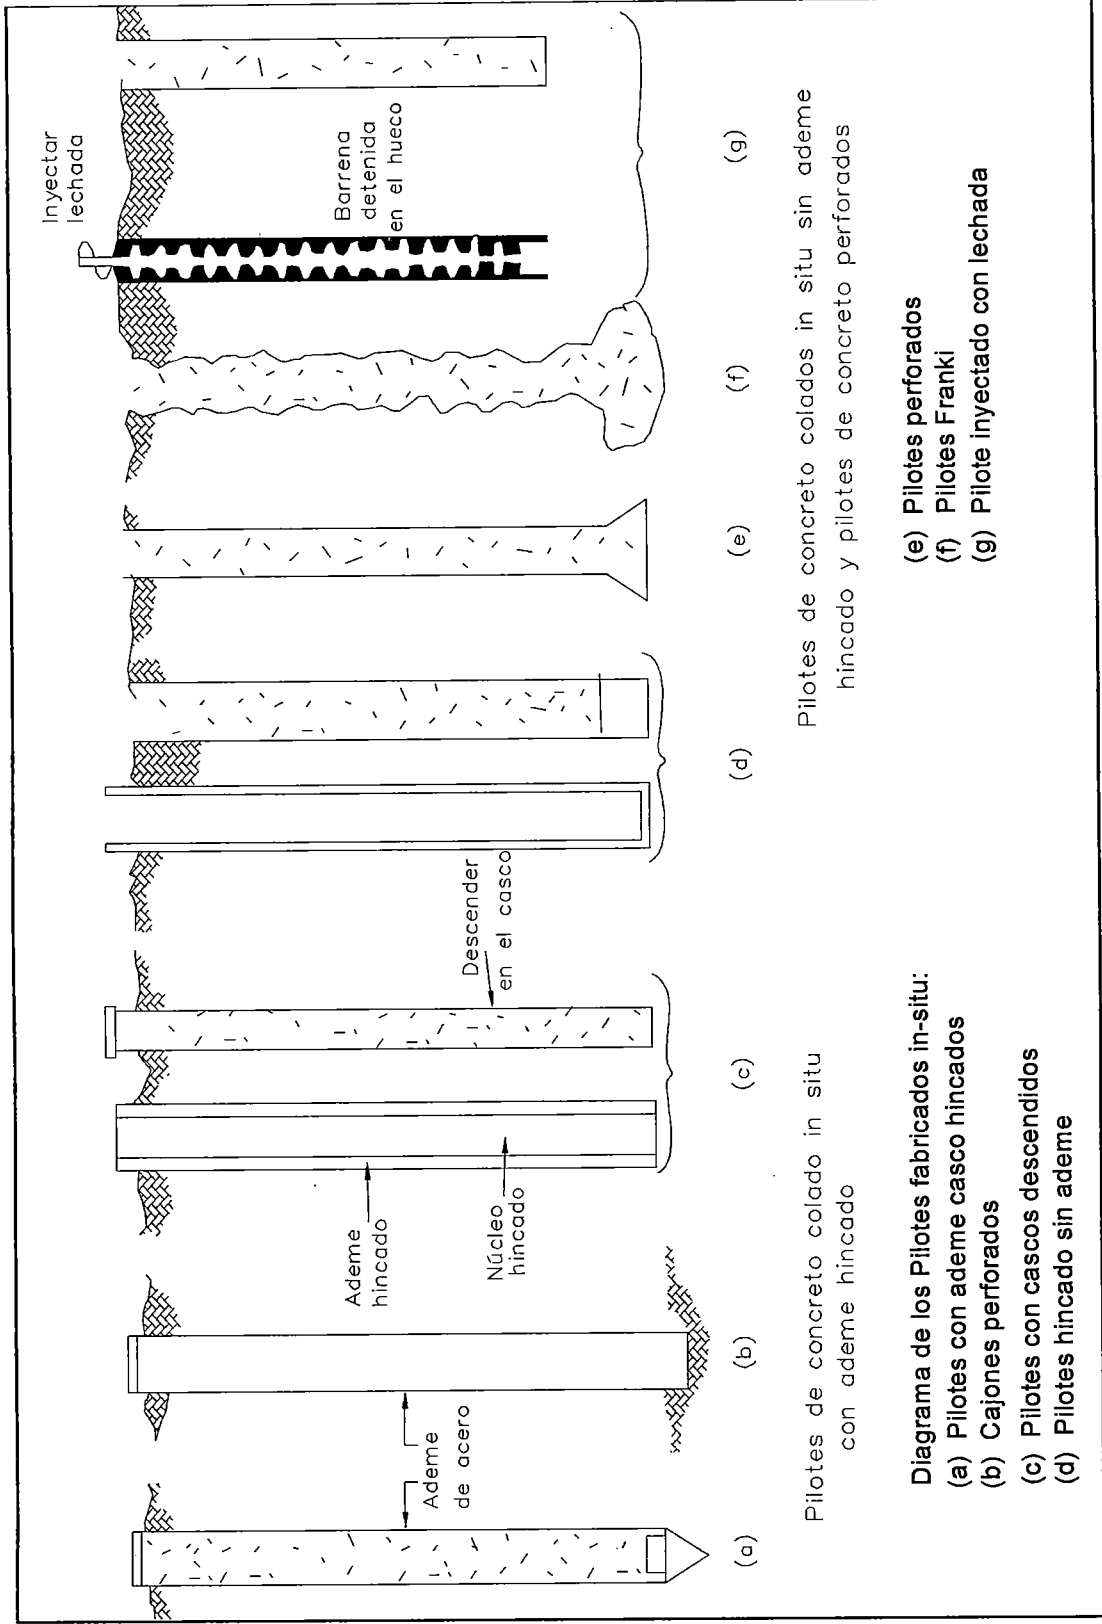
Tipo de Pilotes de Concreto Colados In Situ
